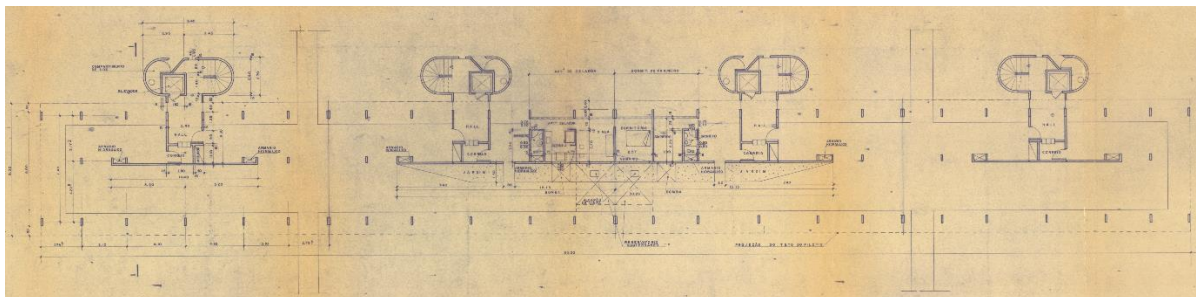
Planta baixa dos pilotis no térreo do R2-72. Fonte: Acervo do Arquiteto Milton Ramos.
